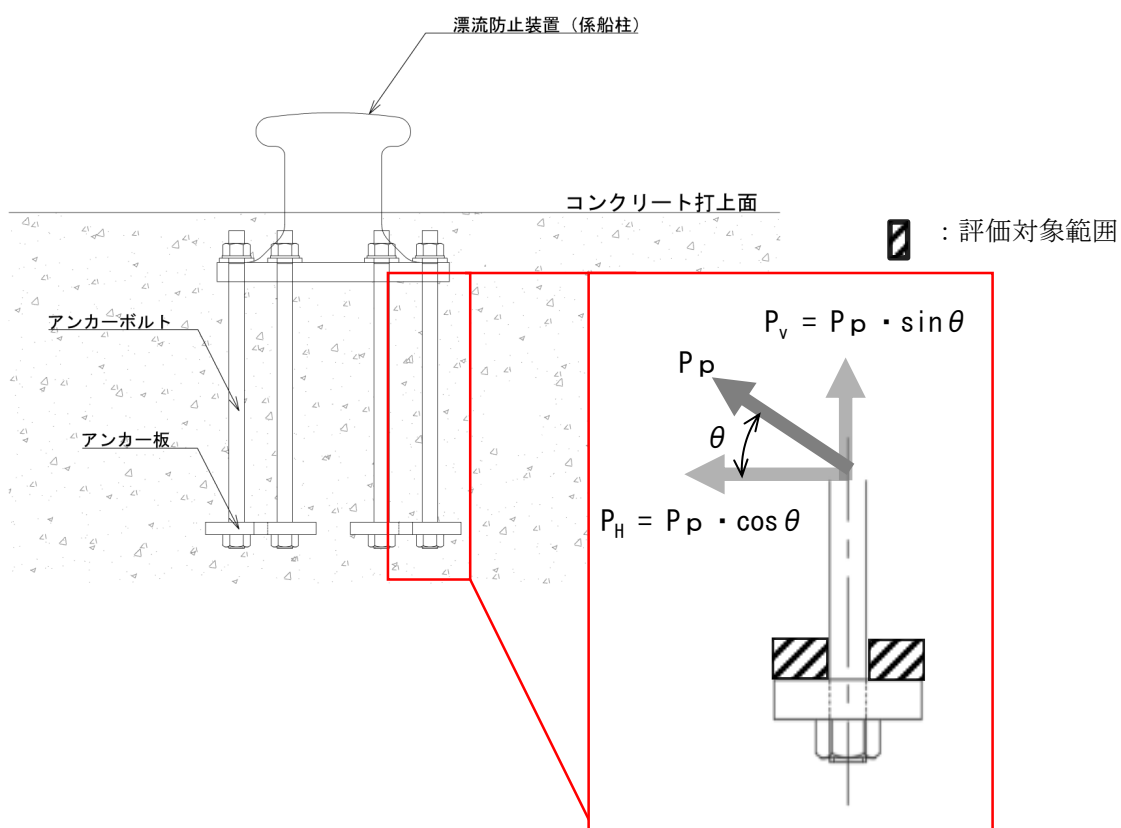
コンクリート（アンカー板上面）のモデル図
